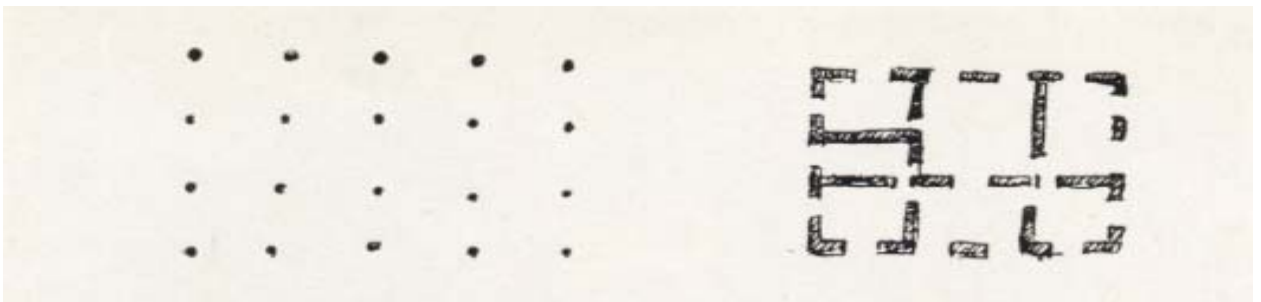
Planta livre x paredes em alvenaria. Fonte: Corbusier e Jeanneret (1965)
